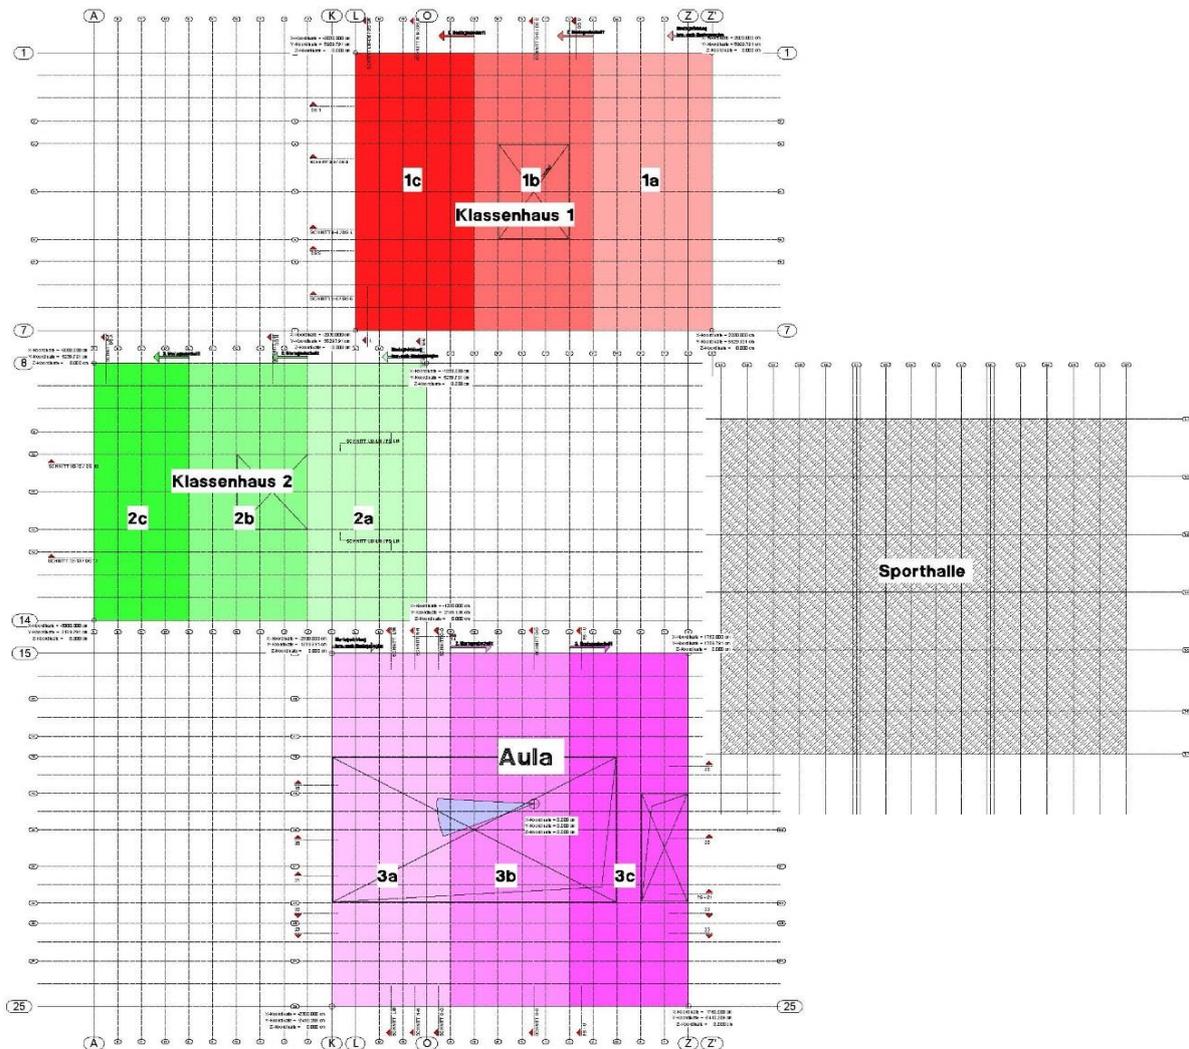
Bauablauf der Klassenhäuser und Aula, Plan Kaufmann Bausysteme
